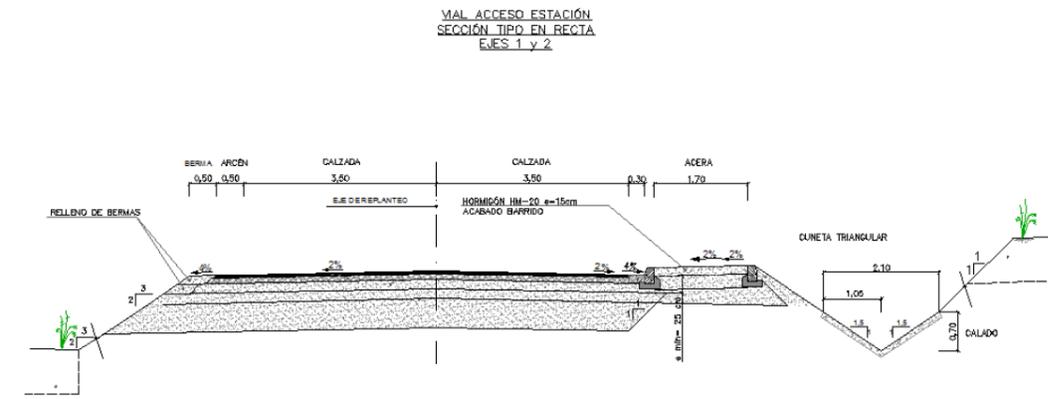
ACCESO ESTACIÓN. SECCIÓN TIPO SEGÚN PROYECTO DE LA ESTACIÓN
